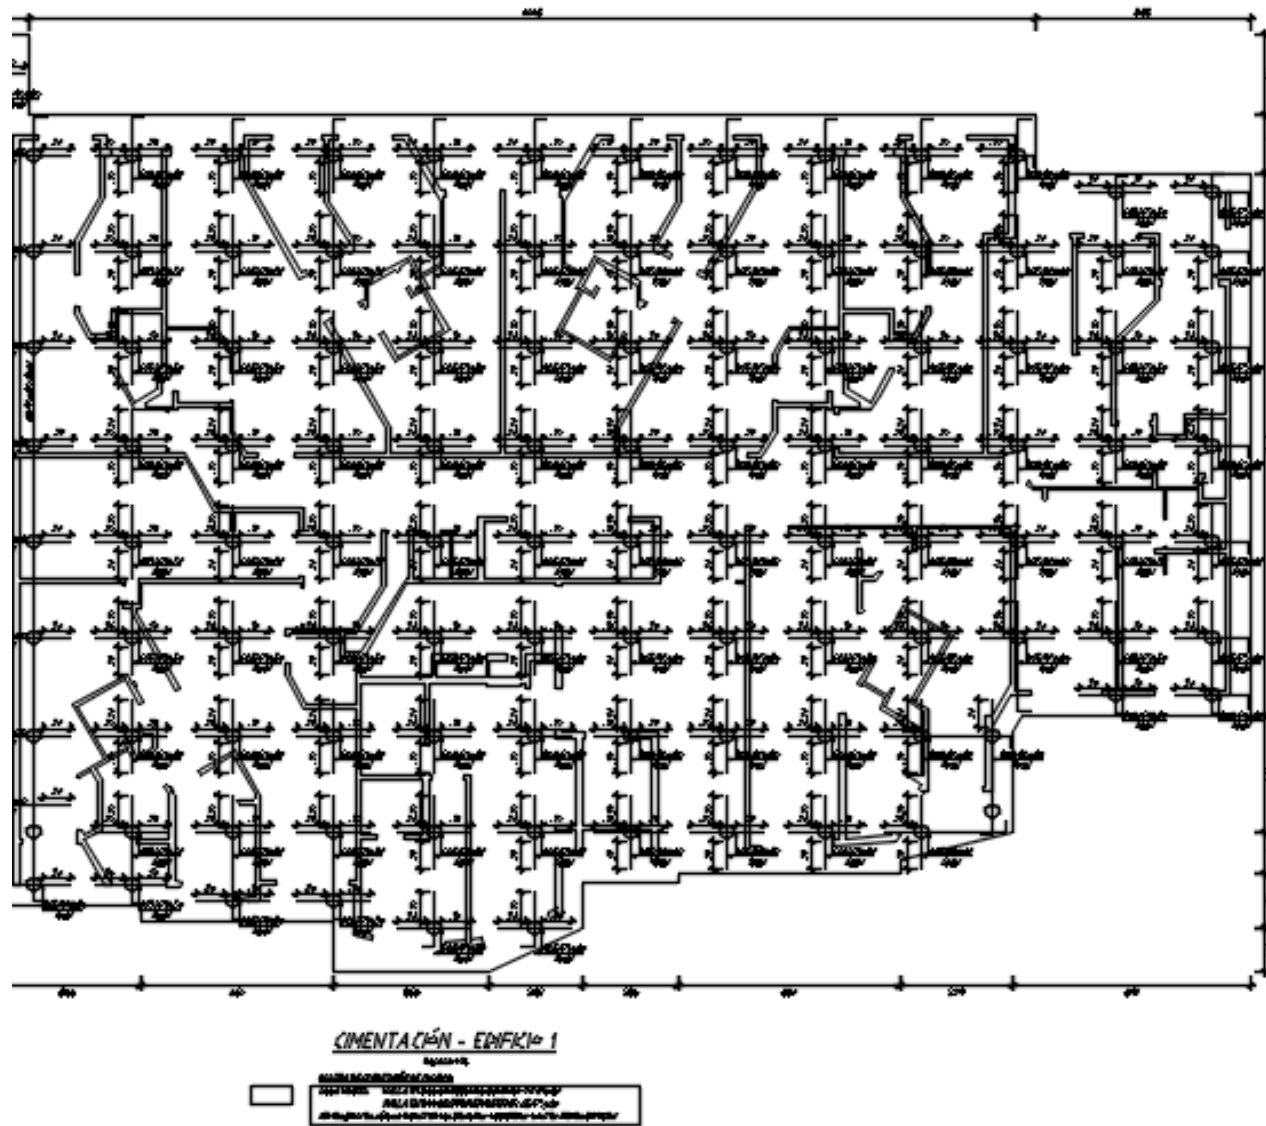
planta de platea de cimentación de proyecto: condominio San Lorenzo. Adaptado de: expediente técnico San Lorenzo, por PRISMA ingeniería 2015
